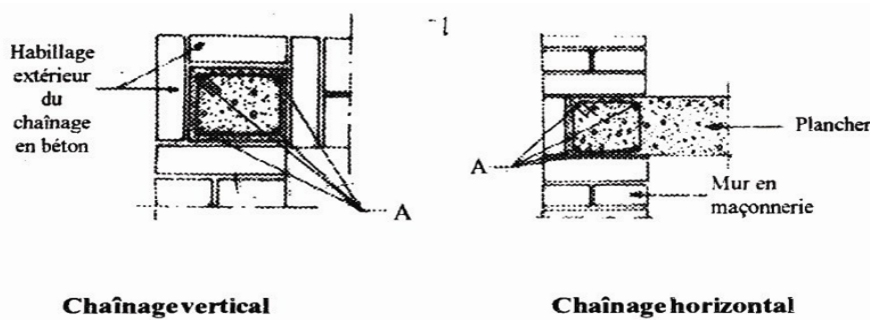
Armatures minimales des chaînages horizontaux et verticaux
